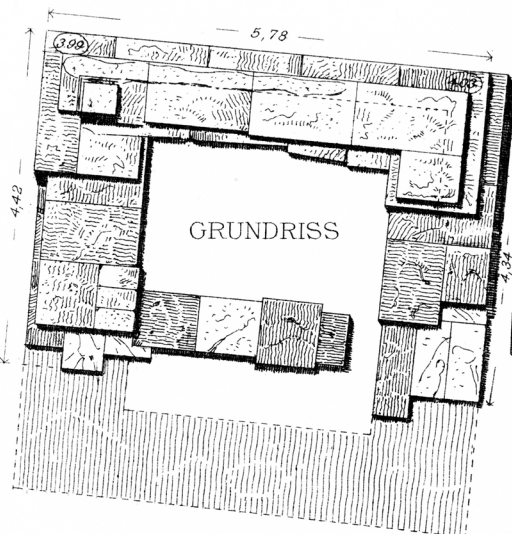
Grundriss und Aufriss von Fundament VIII auf der Schatzhausterrasse (M. 1 : 100)
